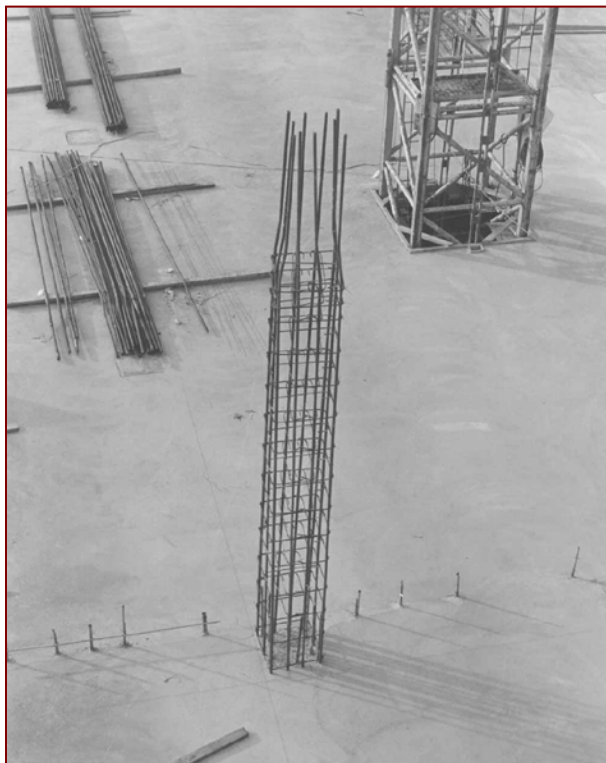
Canasta de armadura para columna con aros. (Fotografía cortesía de J. G. MacGregor)
